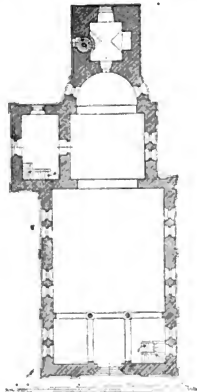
Hlubosch. Grundriss der Kirche.
